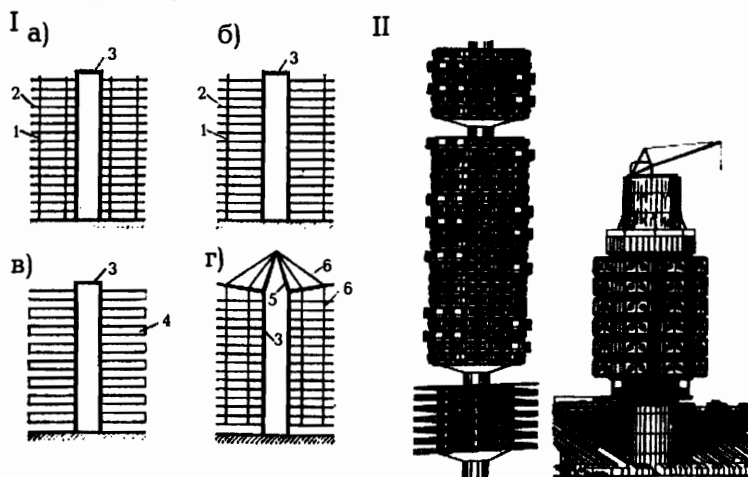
Конструктивные схемы многоэтажных зданий, возводимых методом подъема (I) и проектные решения жилых зданий башенного типа со ствольным ядром жесткости (II): а - при восприятии вертикальных нагрузок колоннами, а горизонтальных - ядром жесткости; б - при восприятии вертикальных нагрузок колоннами и частично ядром жесткости; в - при восприятии вертикальных и горизонтальных нагрузок ядром жесткости на уровне каждого этажа; г - при восприятии вертикальных нагрузок ядром жесткости через верхний оголовок, а горизонтальных нагрузок - ядром жесткости на уровне каждого этажа; 1 - колонна; 2 - плита перекрытия; 3 - ядро жесткости; 4 - конструкция консольного этажа; 5 - конструкция несущего оголовка; 6 - система подвесок
